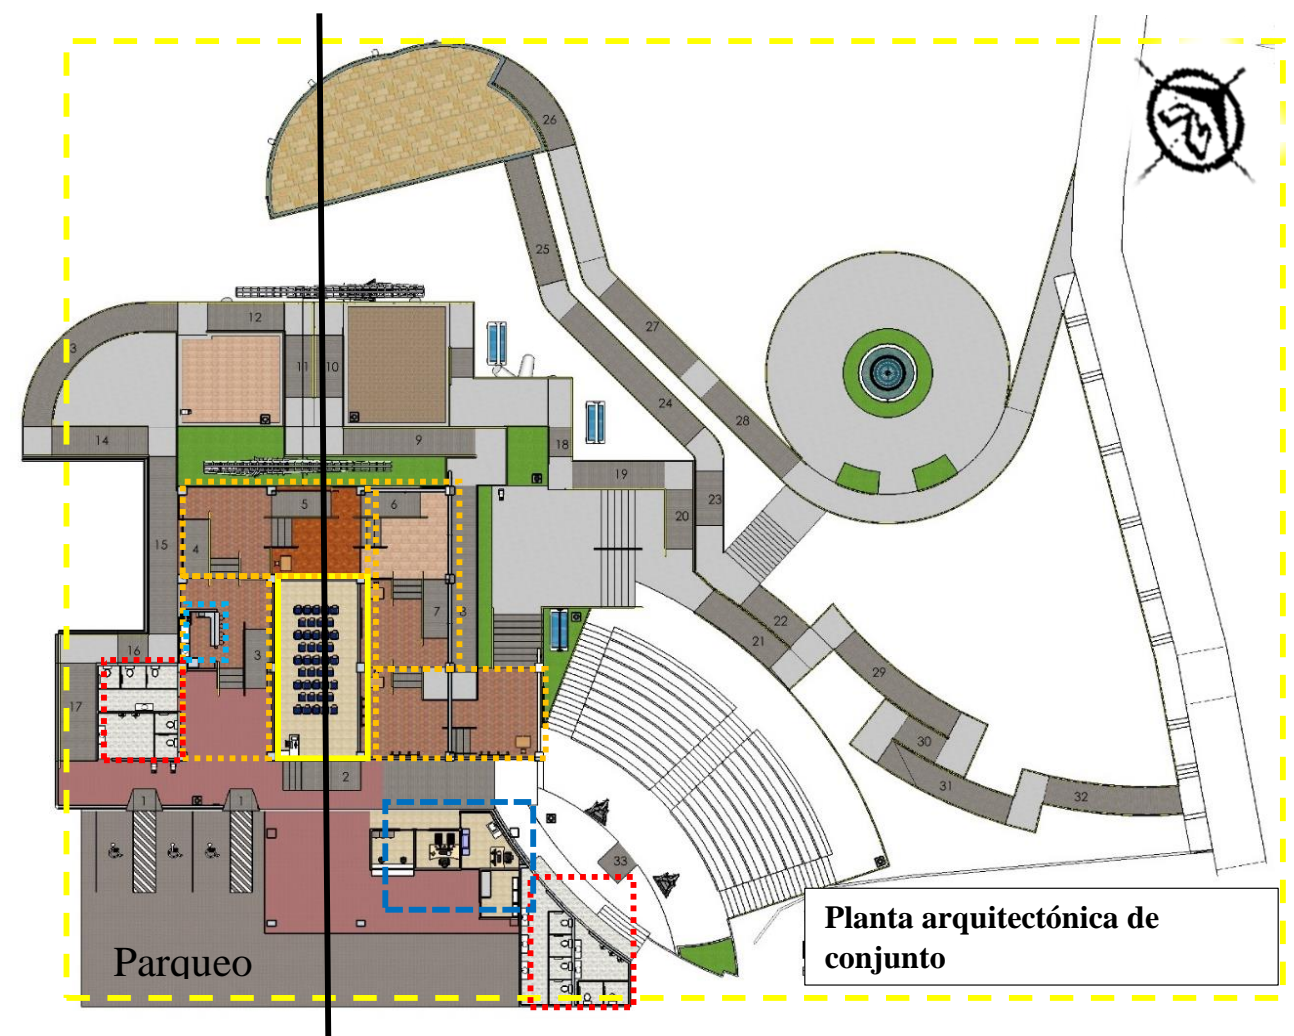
Planta Arquitectónica de conjunto de (CTHSJ).
